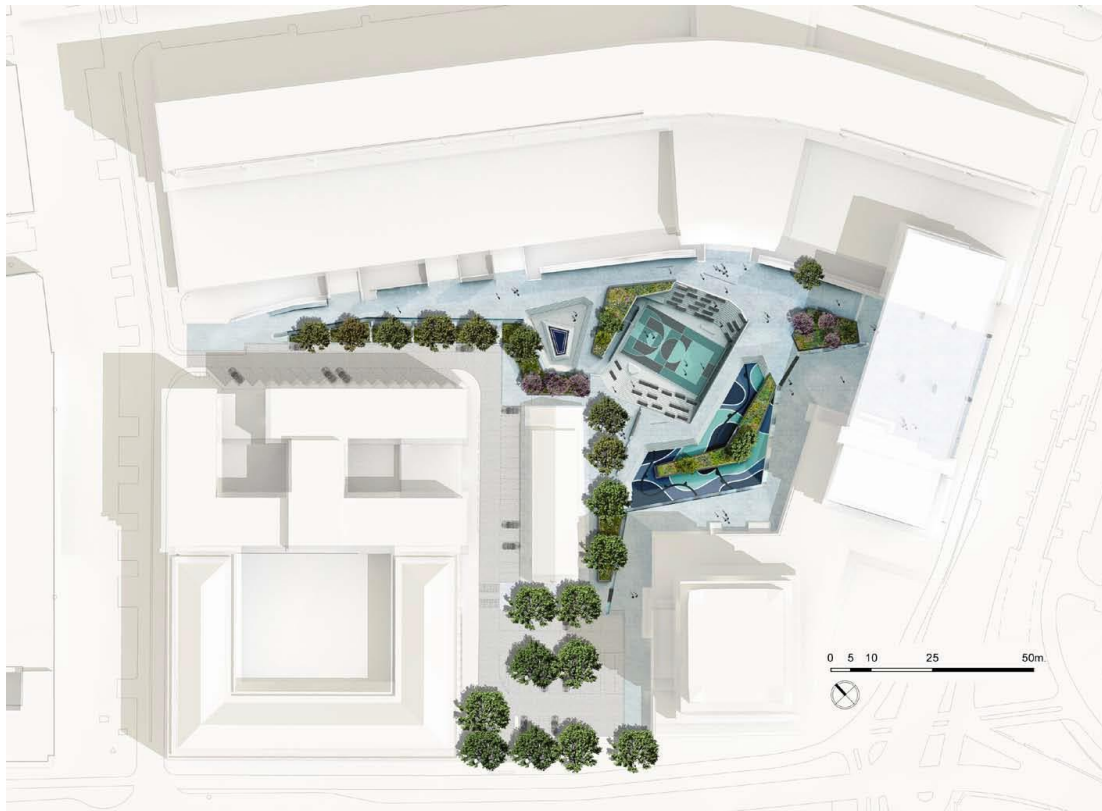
Planta de localização da Praça de Água Bemthemplein. De Urbanisten
